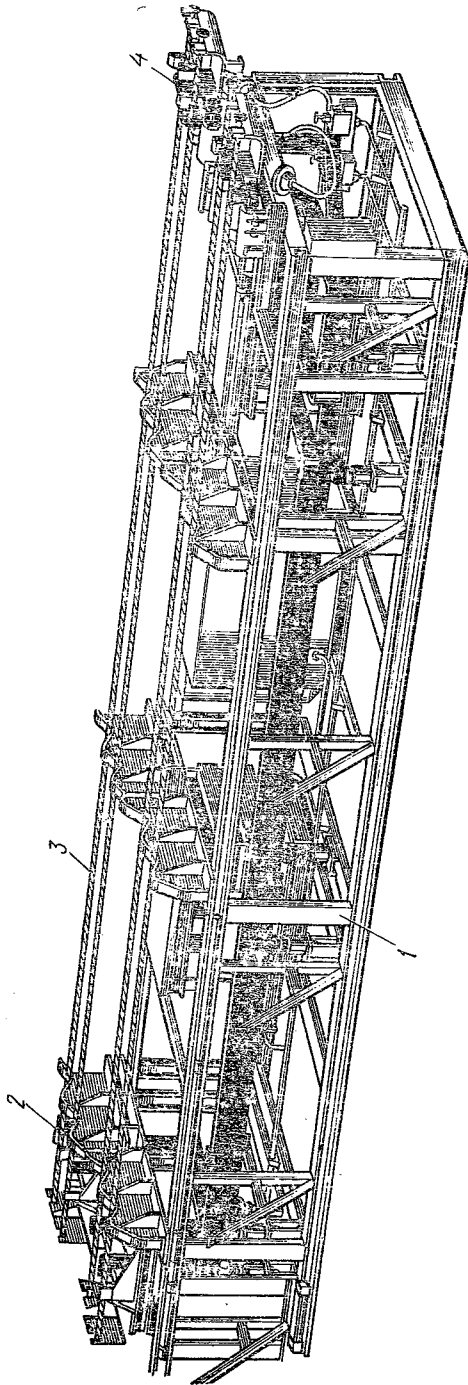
Установка СМЖ-429 для электронного нагрева стержней:
